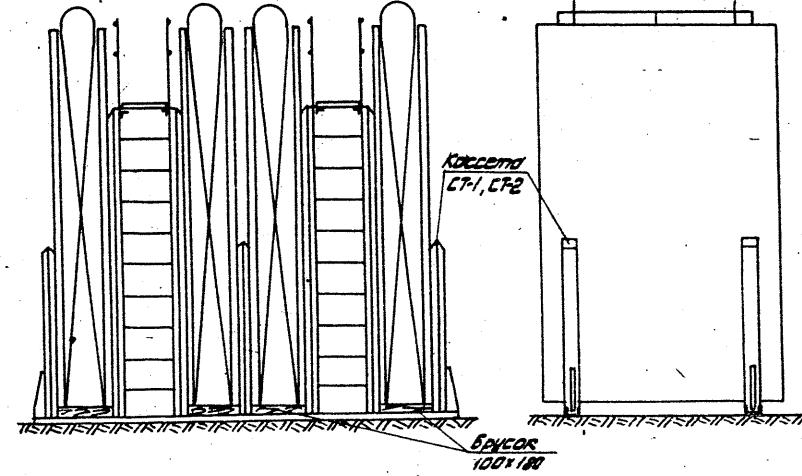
Складирование стенных блоков-ячеек СЯ
